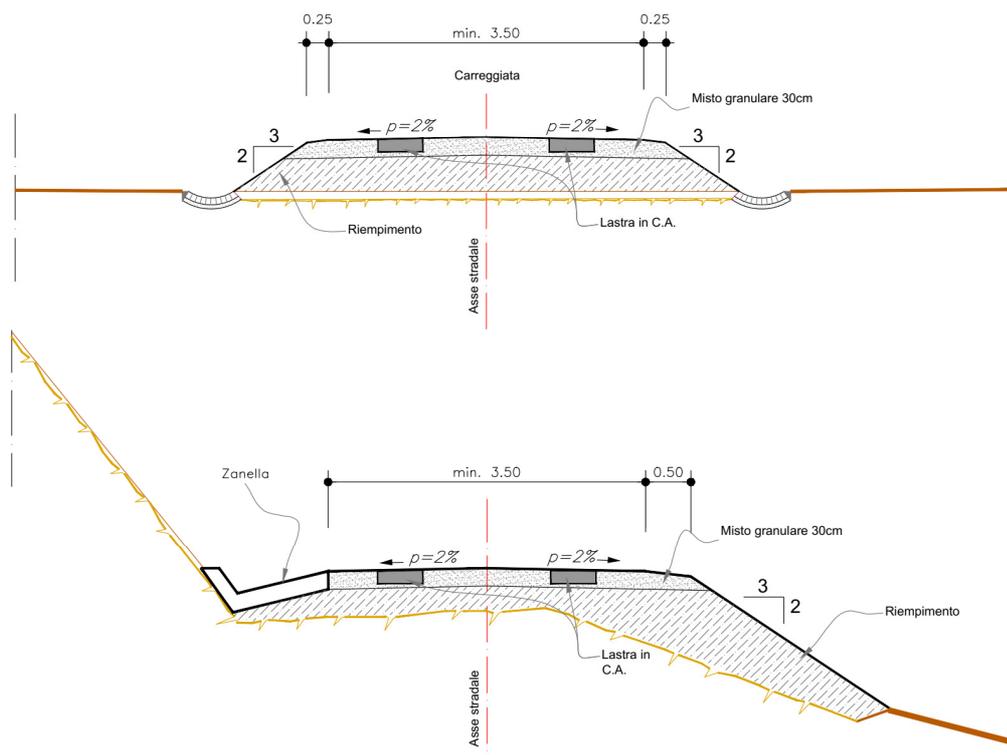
Sezioni tipo di progetto della viabilità di cantiere.
